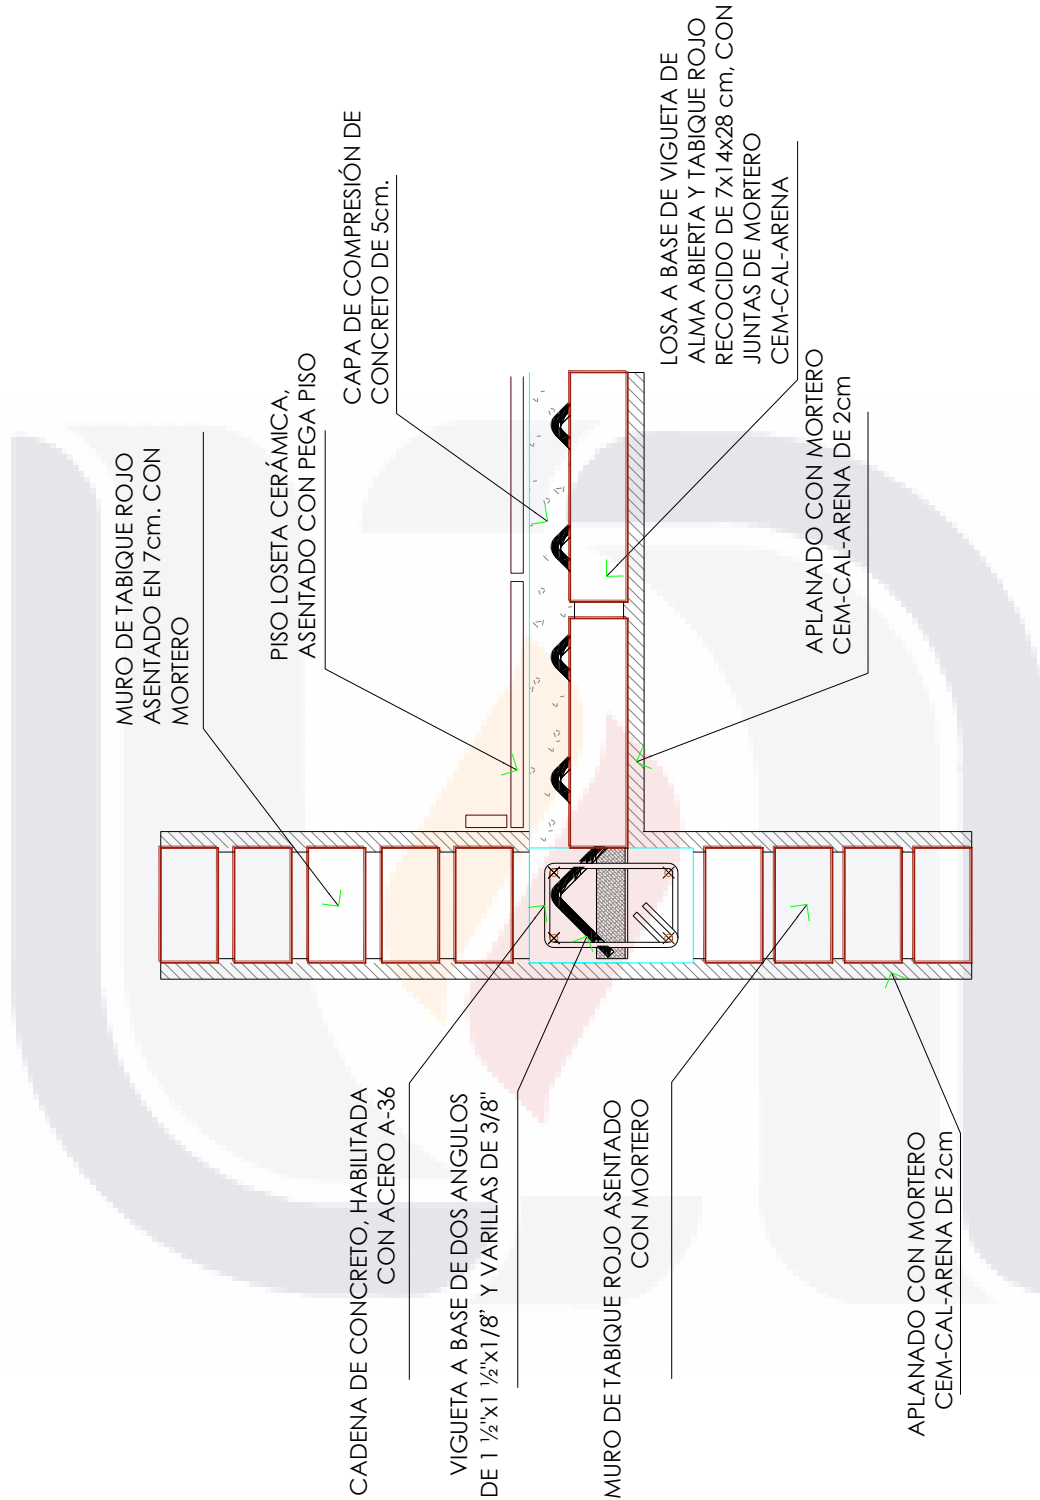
Detalle arquitectónico de la estructura de la losa de entrepiso
